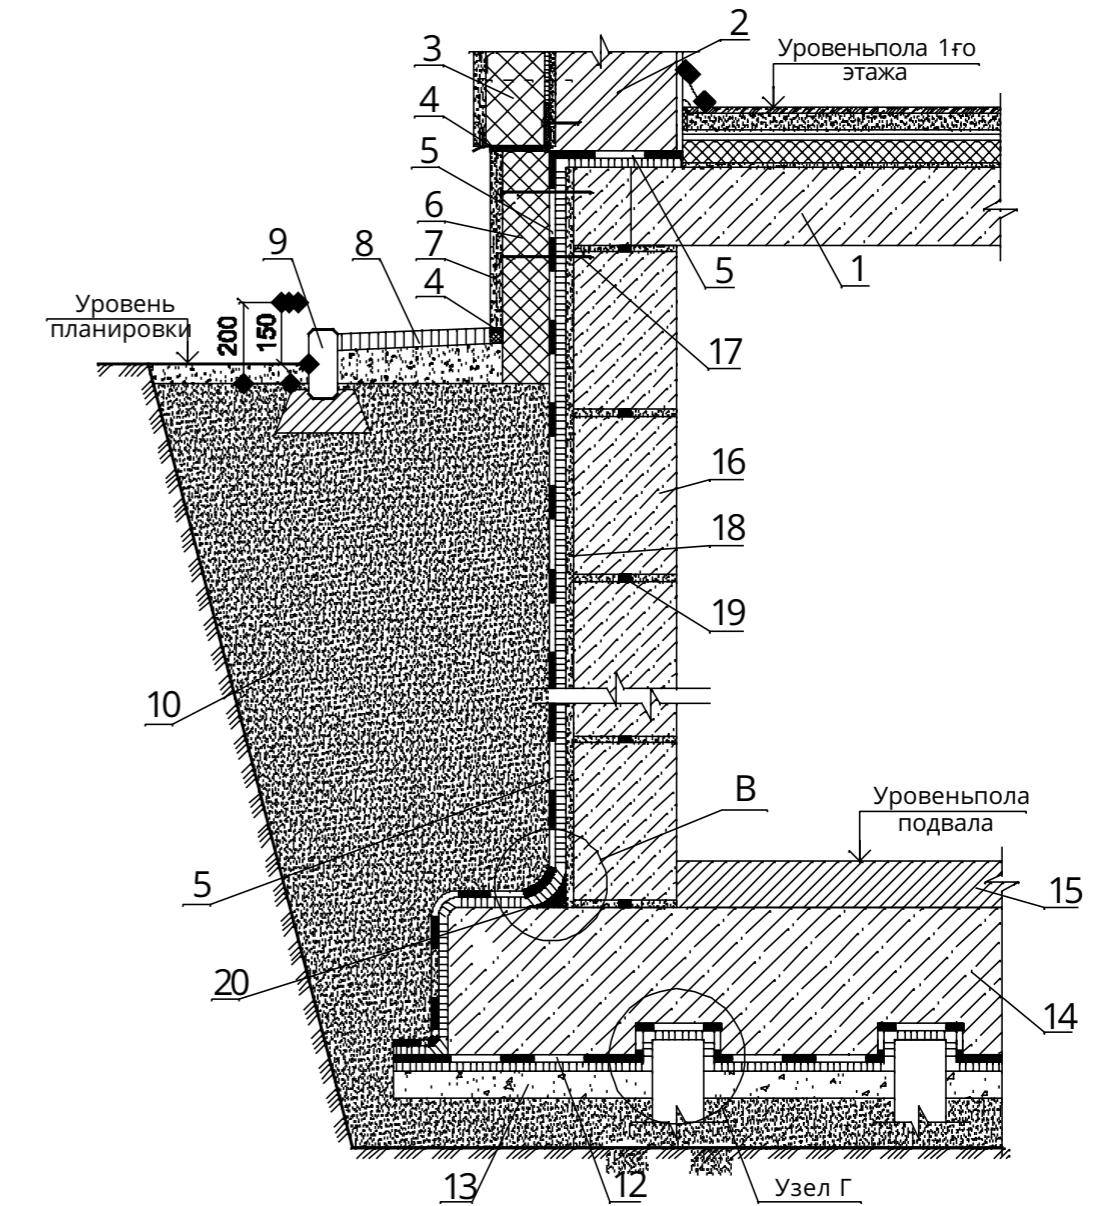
Узел 2. Гидроизоляция стены подвала из блоков и фундаментной плиты здания
